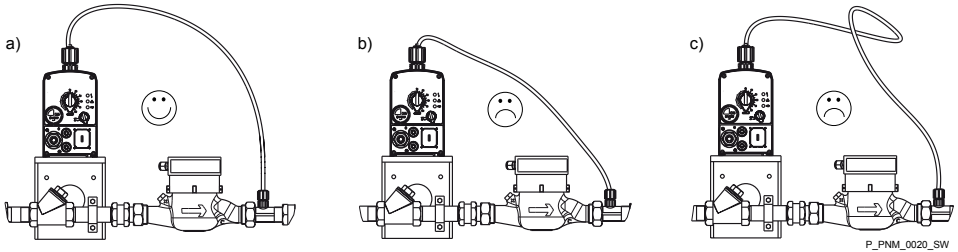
Druckleitung: a) richtige Länge ; b) zu kurz; c) Schleifen
